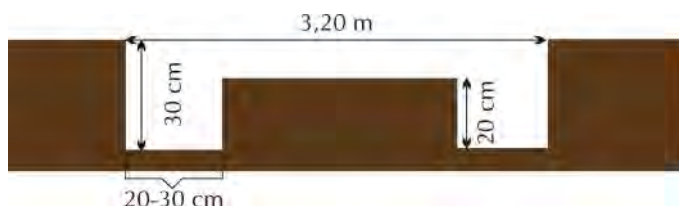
Vista en elevación de la excavación a realizar para la cimentación de la cisterna .
